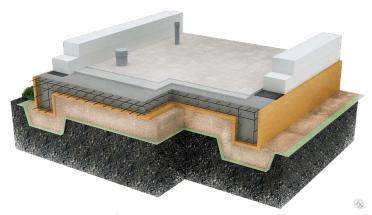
Схема фундаментной плиты с нижними ребрами [8]
